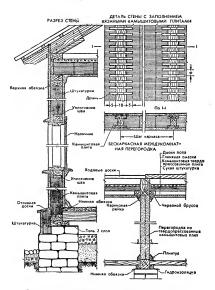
Стены, перегородки и перекрытия с применением камышитовых плит,
